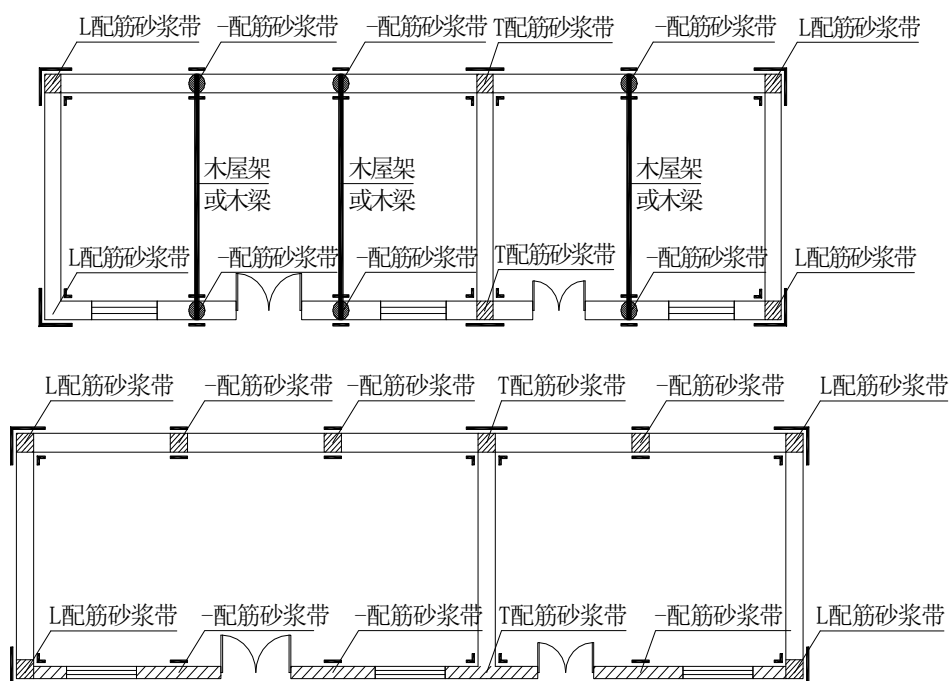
五间房竖向配筋砂浆带的布置示意图
